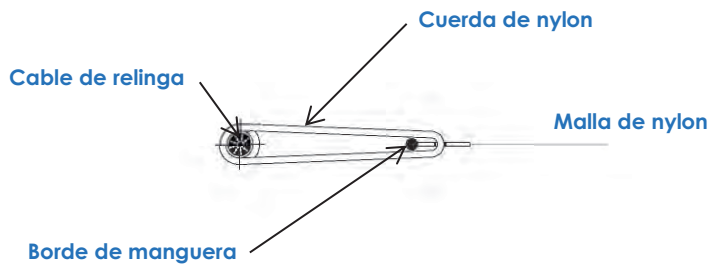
Detalle en corte de sistema acordonado en relinga.
